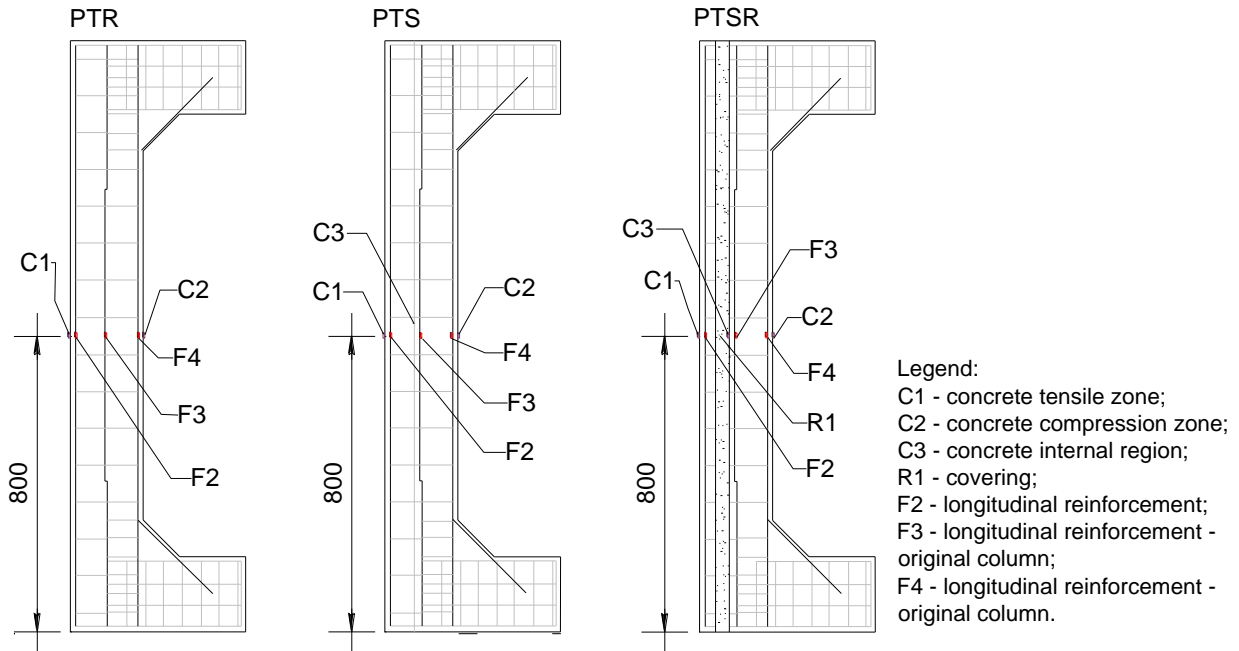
Extensómetros en las barras y concreto de las columnas reforzados de la zona traccionada.
